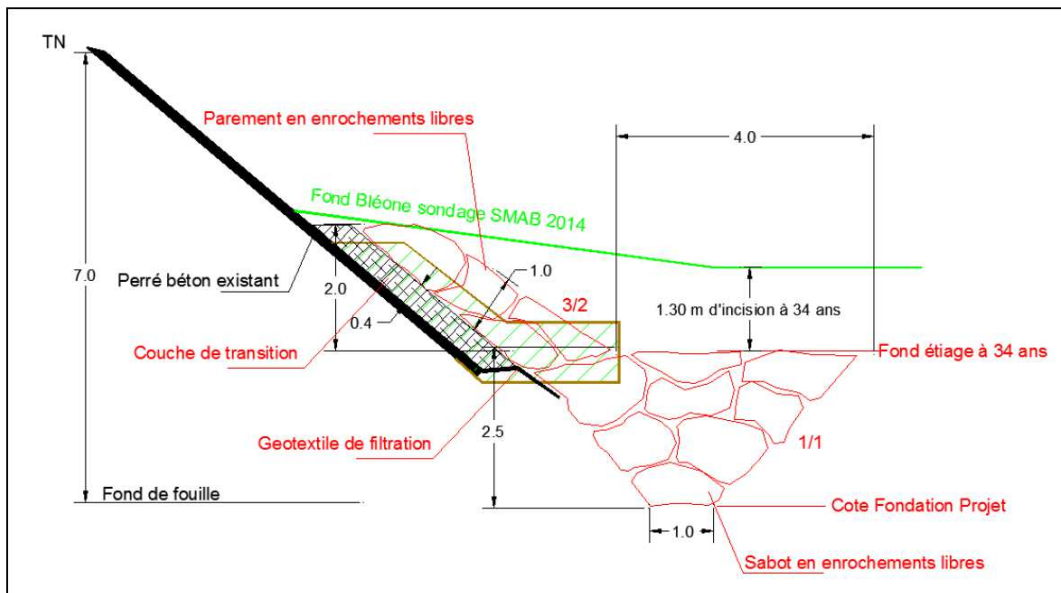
Coupe type des travaux de confortement de la partie aval de la digue du plan d'eau des Ferréols
